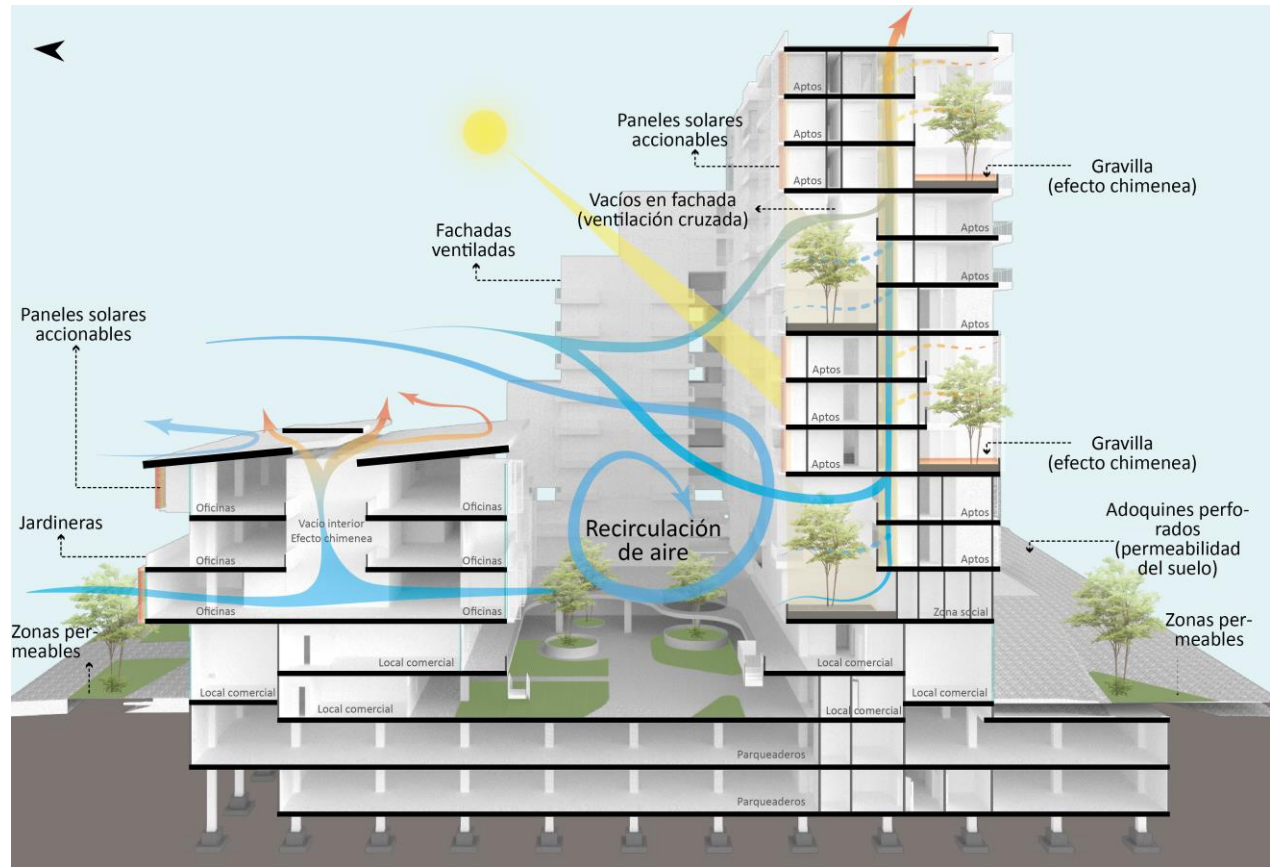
Esquema de fachadas ventiladas con paneles solares accionables.
